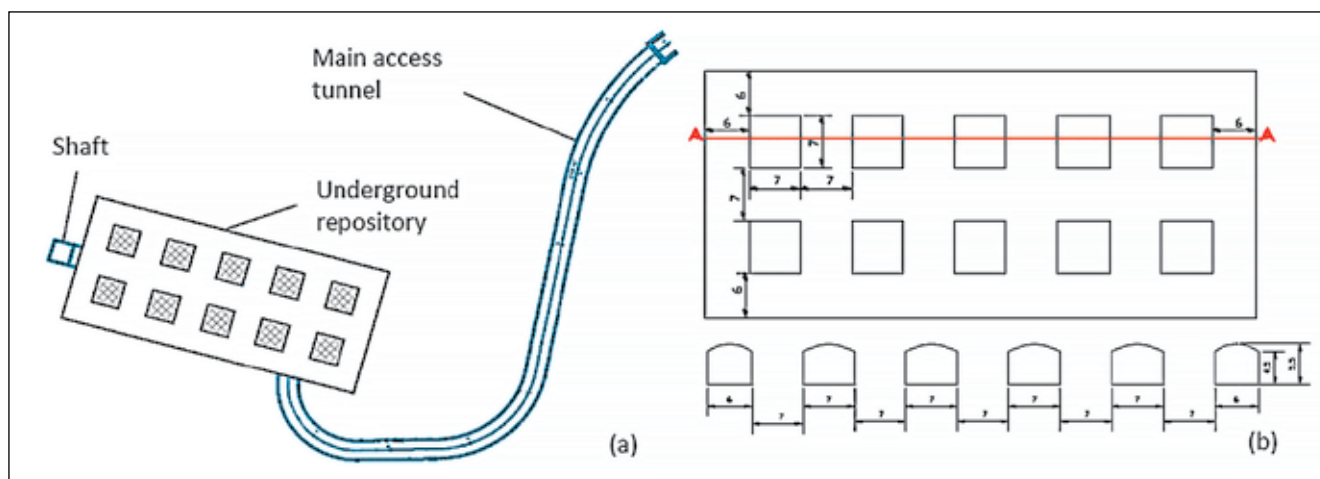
Подземное хранилище опасных грунтов в Греции, а) общий план подземного комплекса, б) план и разрез системы расположения полостей (камер) хранения и опорных целиков.
